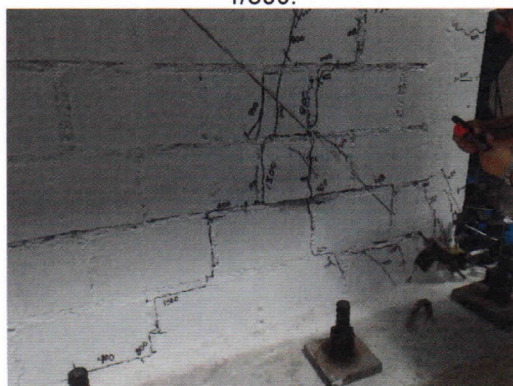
Levantamiento de ladrillo en la parte inferior Oeste de la cara Norte para una distorsión de 1/300.
